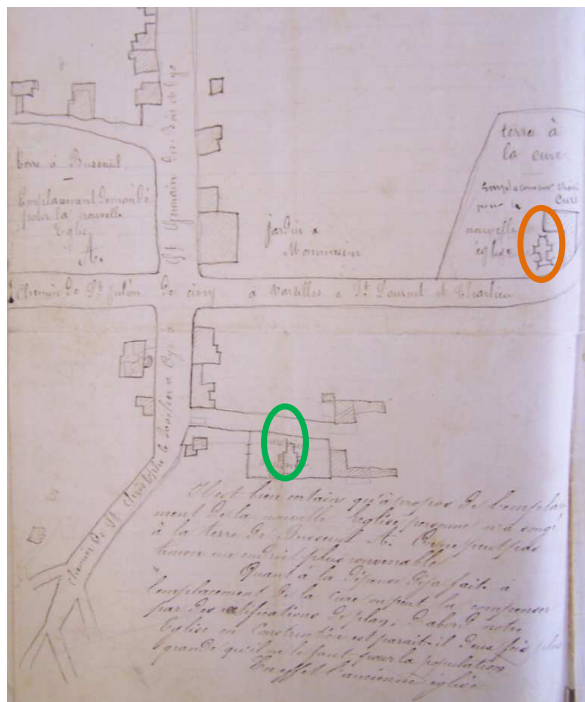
Plan dressé en vue de la construction de la nouvelle église (ADSL – O27).
